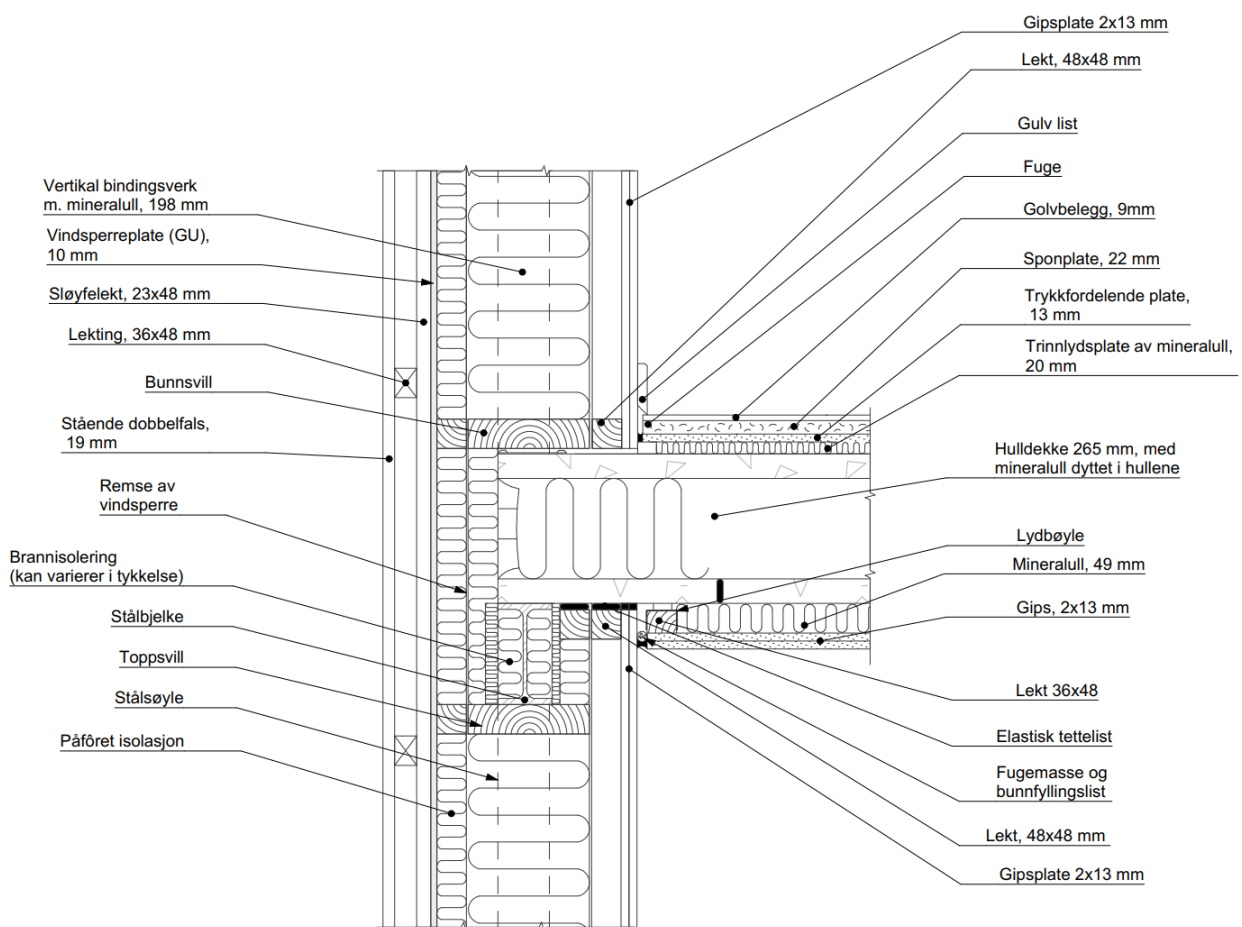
Overgang yttervegg/etasjeskiller: Betong
